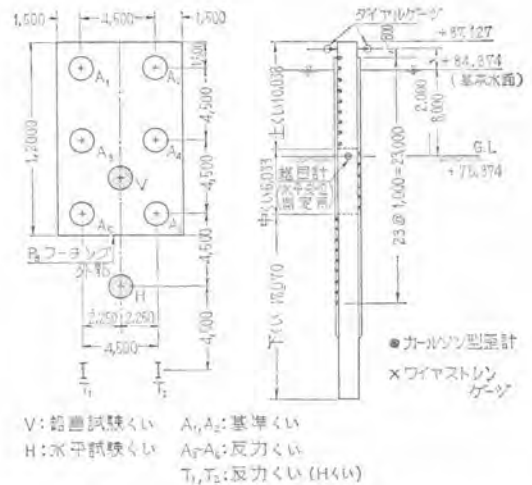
(a) 試験くいの配置図 図-9(b) 試験くいの長さおよび計器配置図
